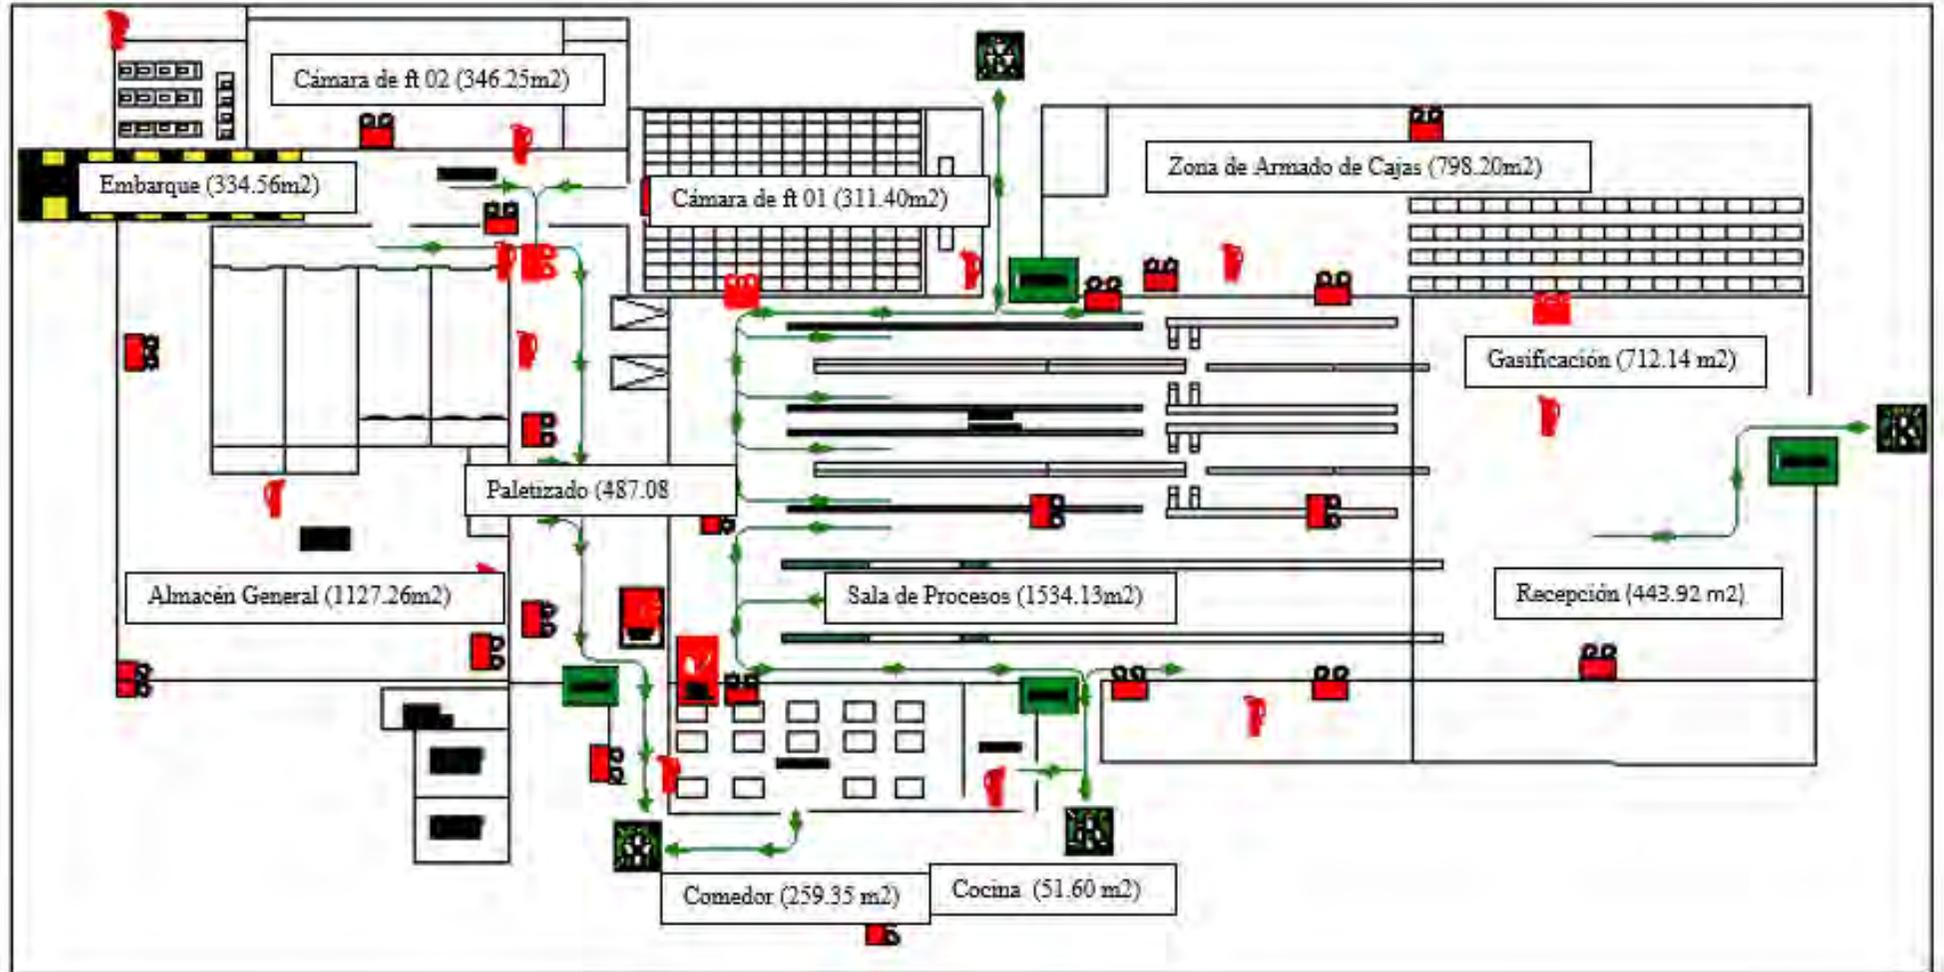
Planta de procesamiento, fondo maestranza, Manuelita.
